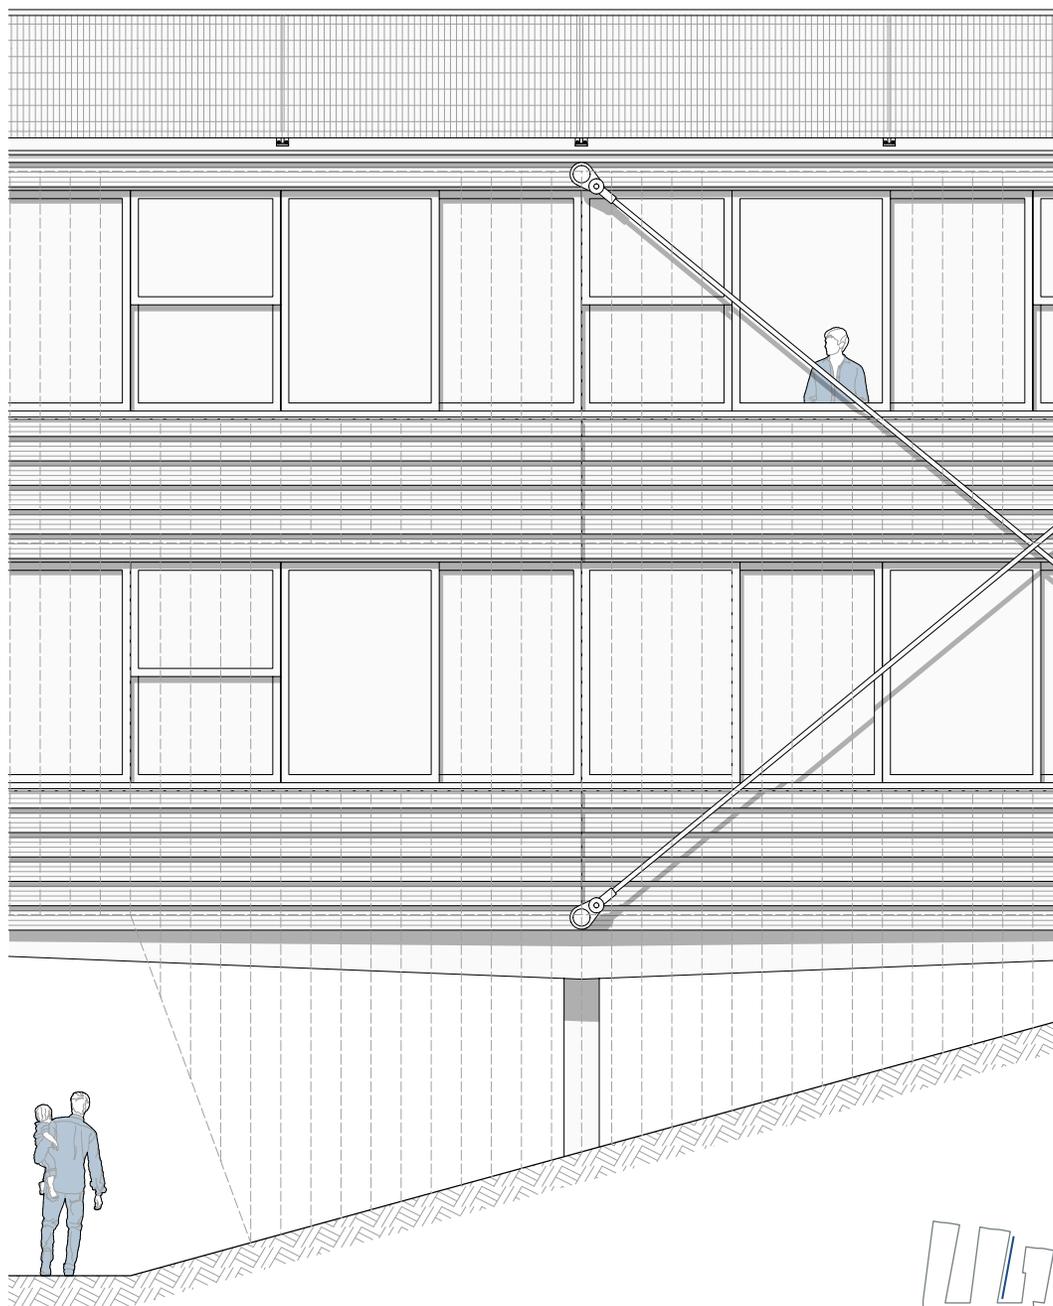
Fassadenschnitt und Fassadenansicht 1:75
